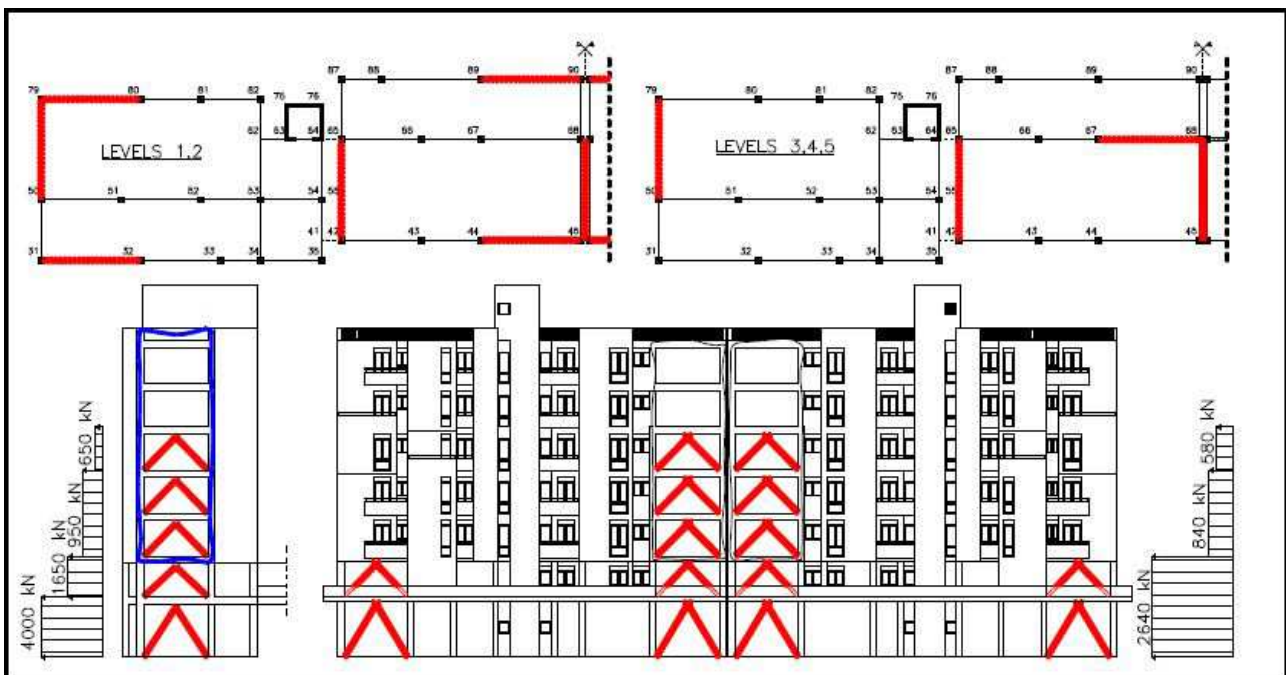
Disposizione dei controventi in pianta (sopra) e in altezza (sotto)
